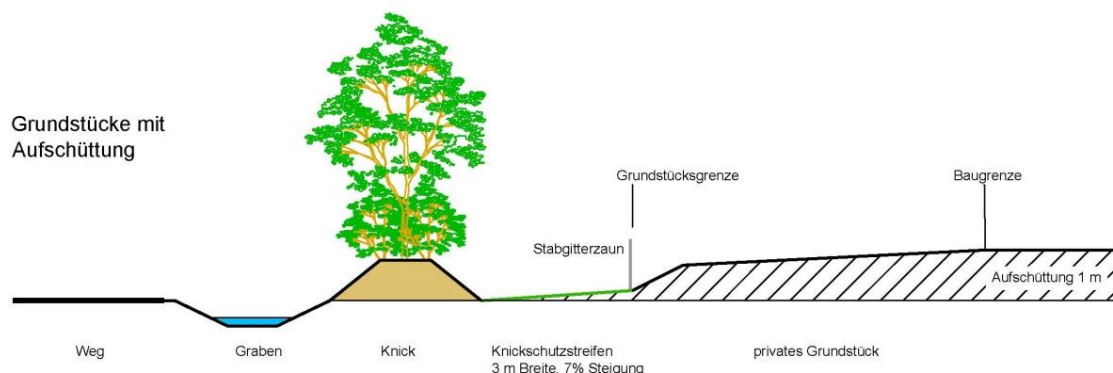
Schnitt der geplanten Bodenauffüllungen im südwestlichen Geltungsbereich
